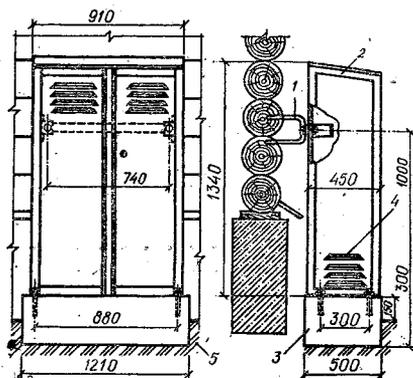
Установка шкафа для двух баллонов у деревянной стены дома:
